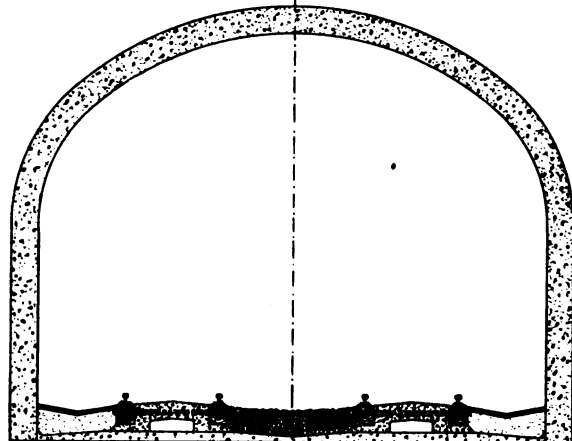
u. 95. Tunnel der N. Y. Untergrundbahn mit Gleisbettung nach J. W. Schaub.
